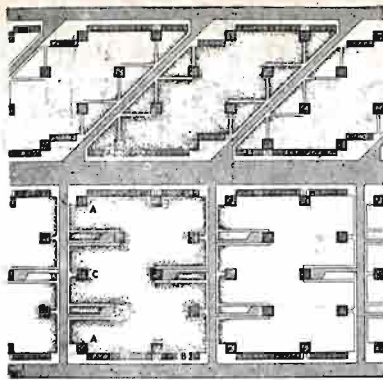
i 537. Plan kolonji w Pradze Czeskiej
